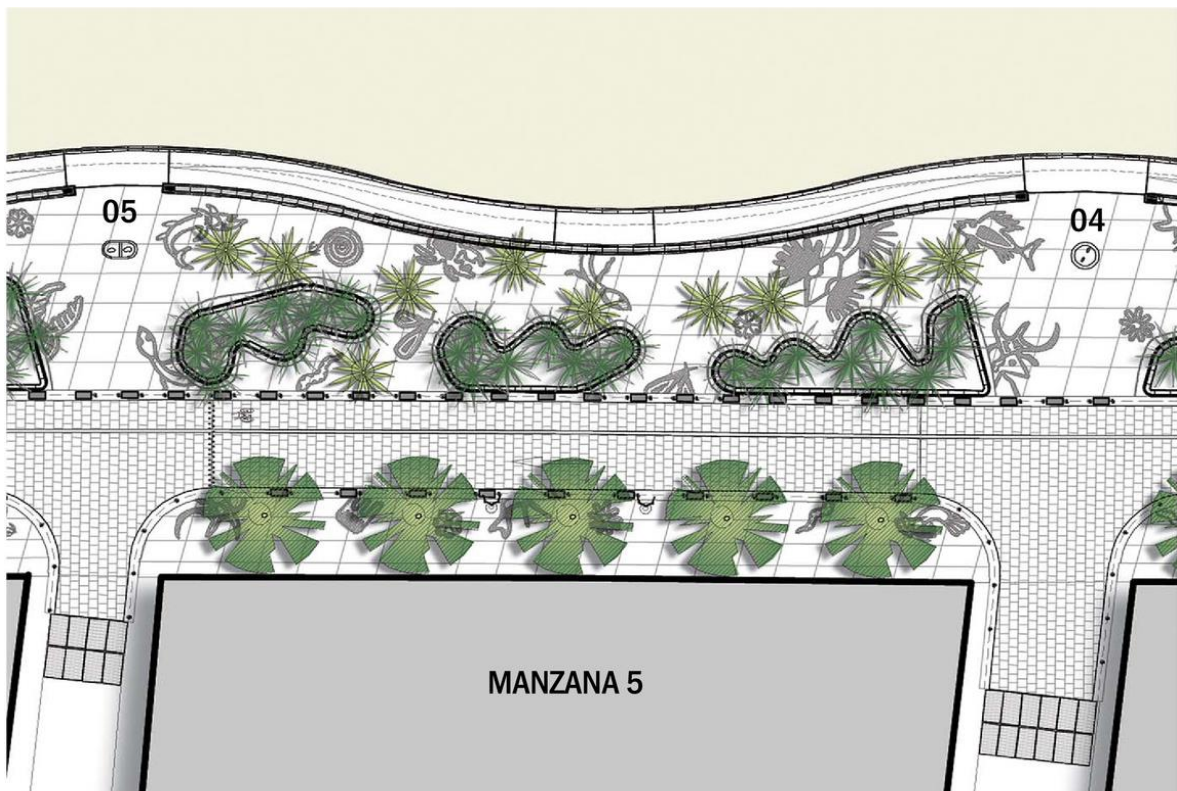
Ilustración VIII-18 Detalle en alzado de jardineras en Manzana 5
